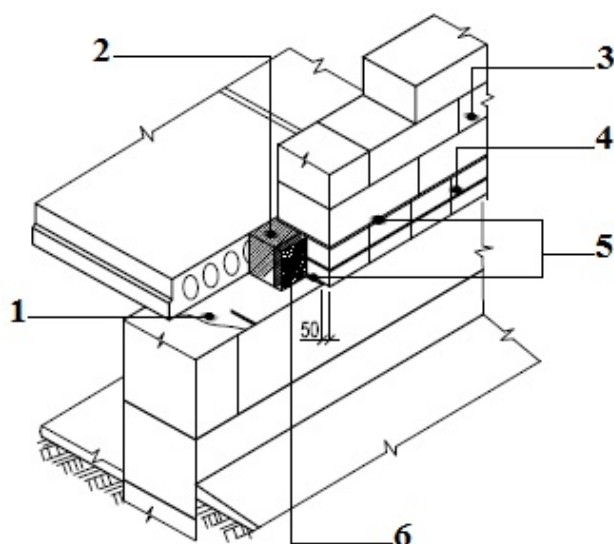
Схема устройства цоколя в местах опирания плит перекрытий: 1 — гидроизоляция; 2 — монолитный железобетонный пояс; 3 — блоки YTONG; 4 — доборные блоки; 5 — цементно-песчаный раствор; 6 — эффективный утеплитель
